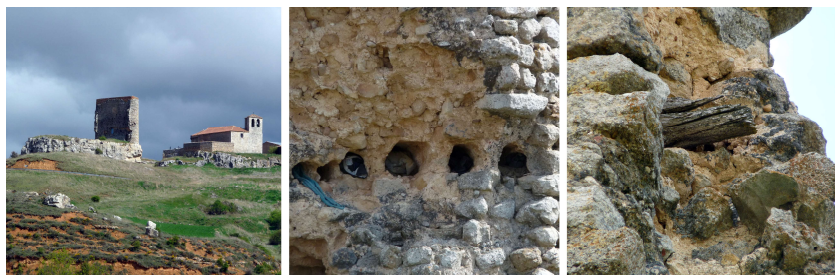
Castillo de Soliedra (Soria). Vista exterior y de la ruina intencionada, donde se advierte en el corte de los extremos los restos de las vigas de madera situadas en dos niveles
